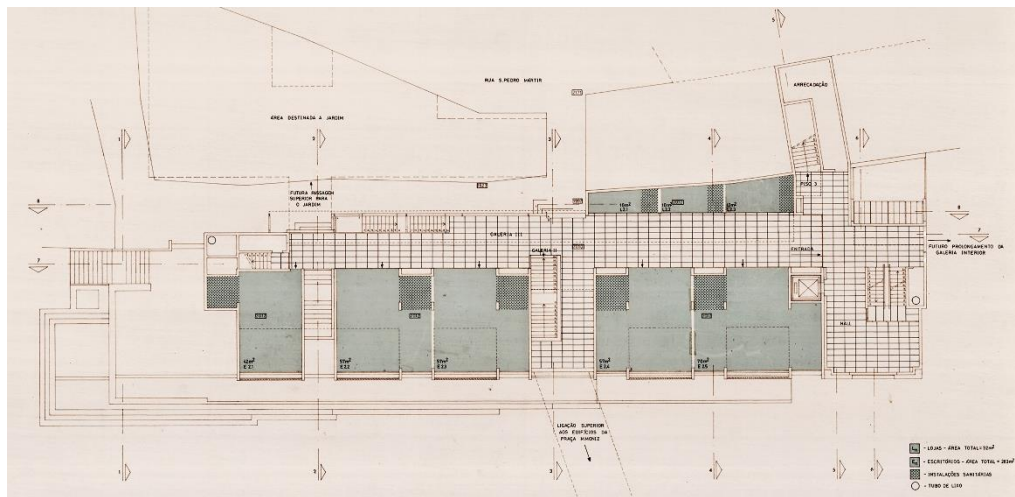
Planta do Piso 2, Projeto Geral – 1ª Fase, Rua do Marquês de Alegrete - EPUL, fevereiro de 1974.
